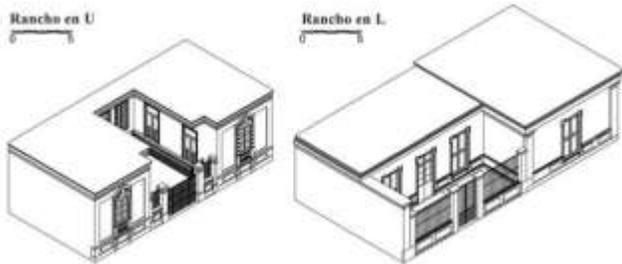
Tipos de rancho. Barranco. Elaboración M. Sarmiento
